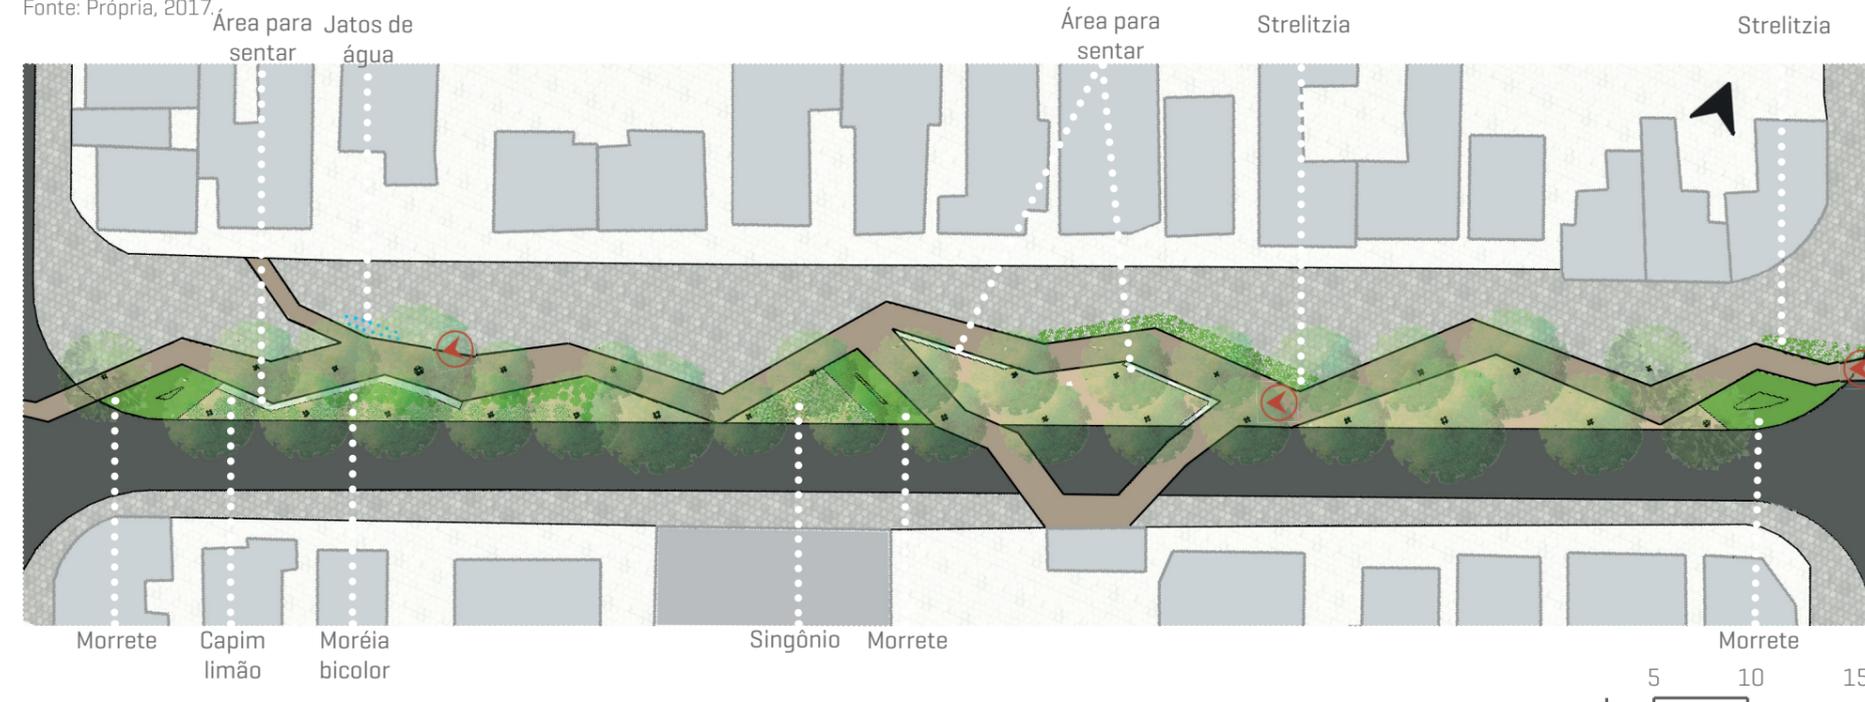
| Esquema explicativo da construção da proposta para a quadra 02 do trecho 03
